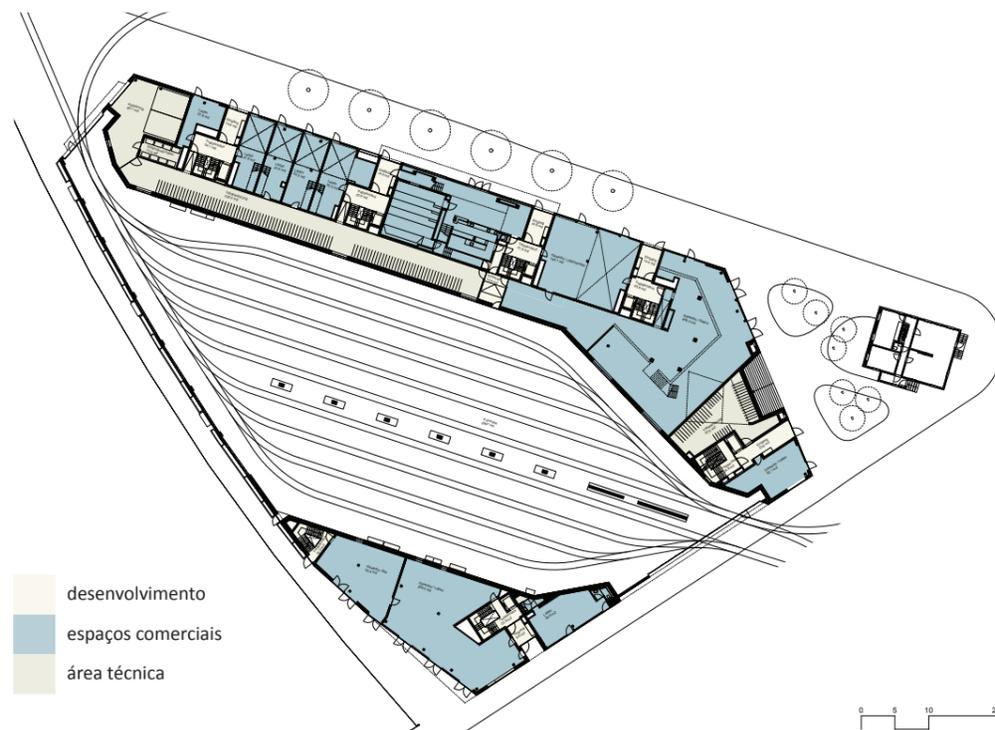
Planta do rés-do-chão do complexo de Kalkbreite
